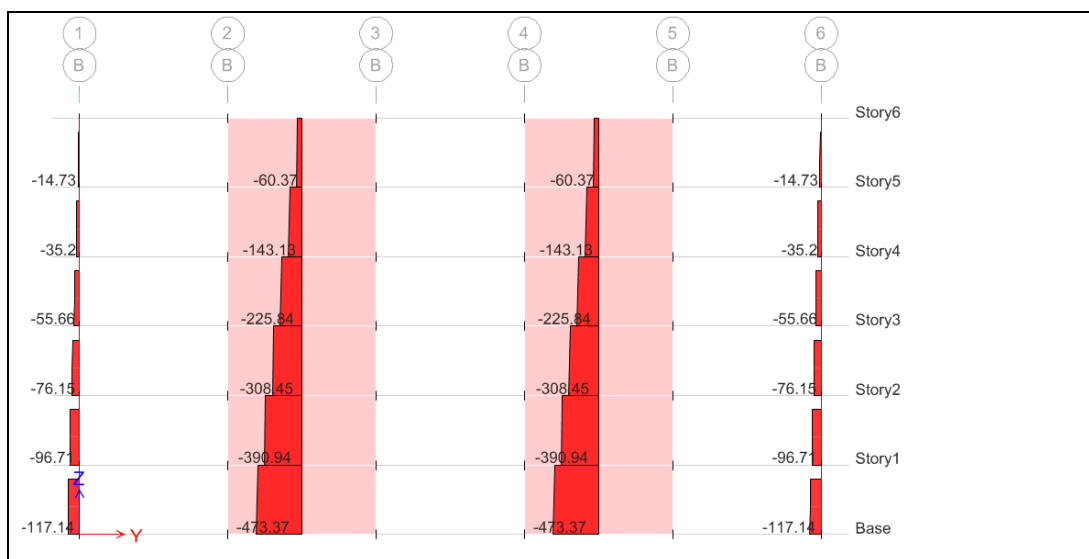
Fuerzas axiales eje B por acción de las cargas verticales.
